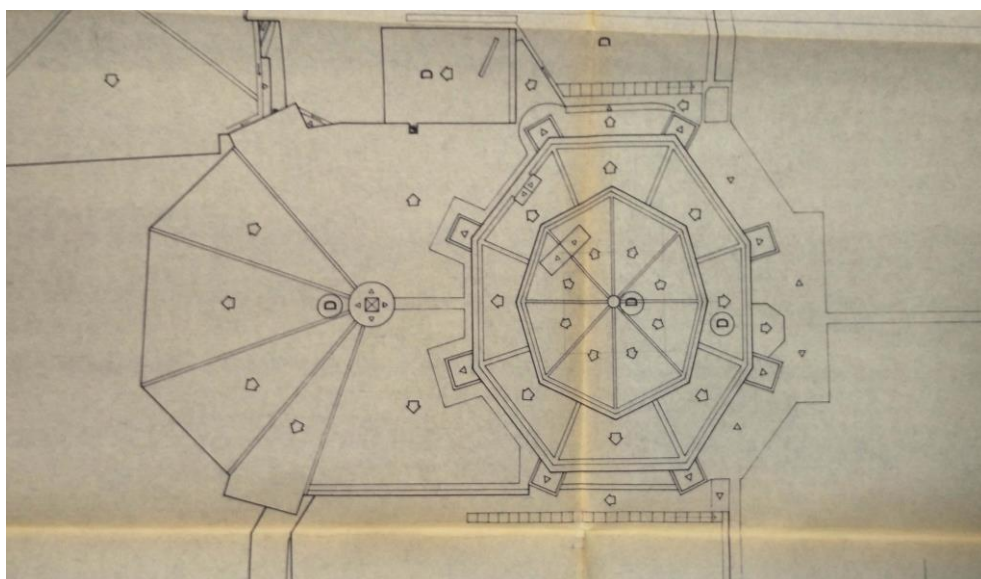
Cubiertas del transepto estado original. Archivo Administración D.G.A.
